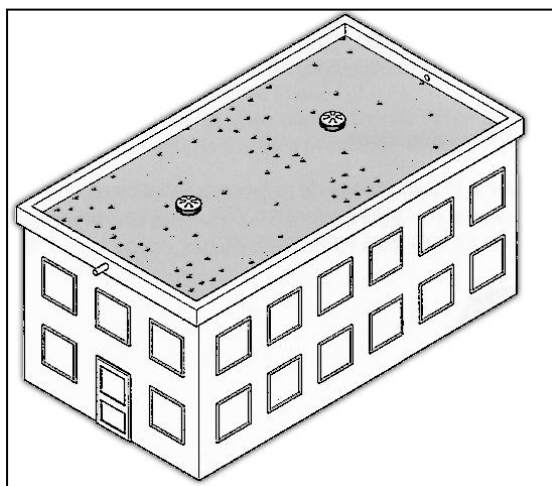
Aplicação do sistema sifónico em cobertura plana[22]
